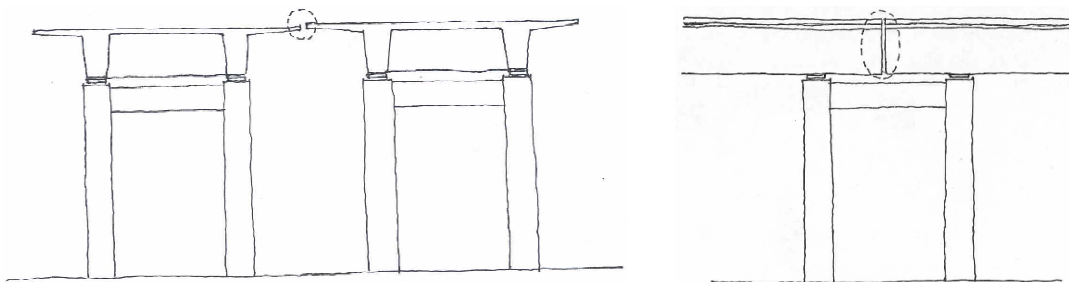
Giunti longitudinali tra vani o tra impalcato e spalla, o giunti trasversali tra impalcati.
